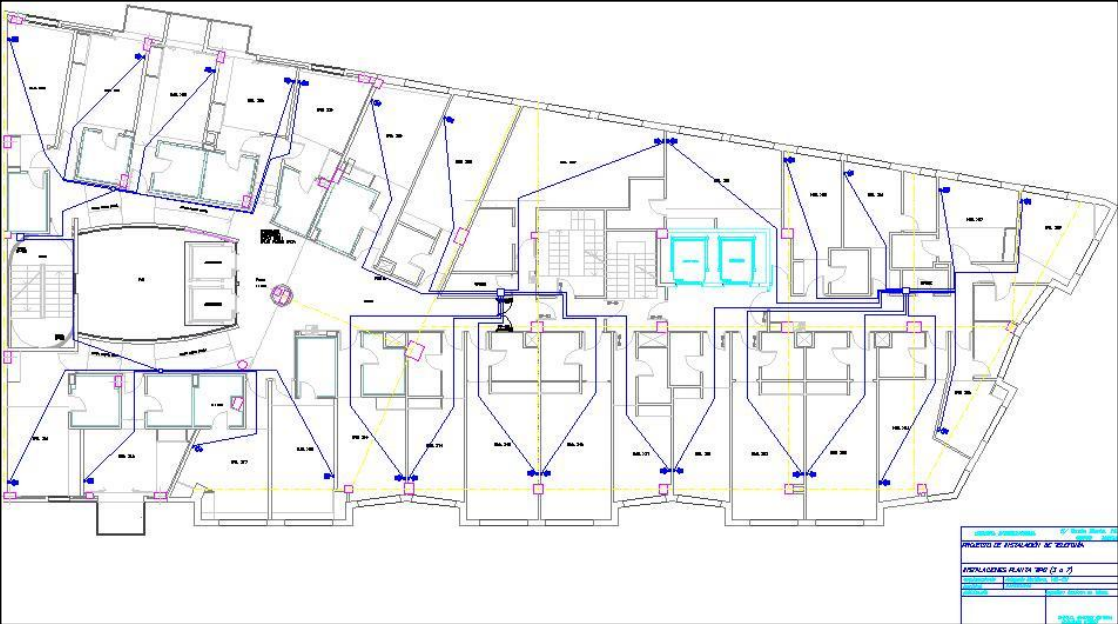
Plano de distribución de telefonía de planta tipo
